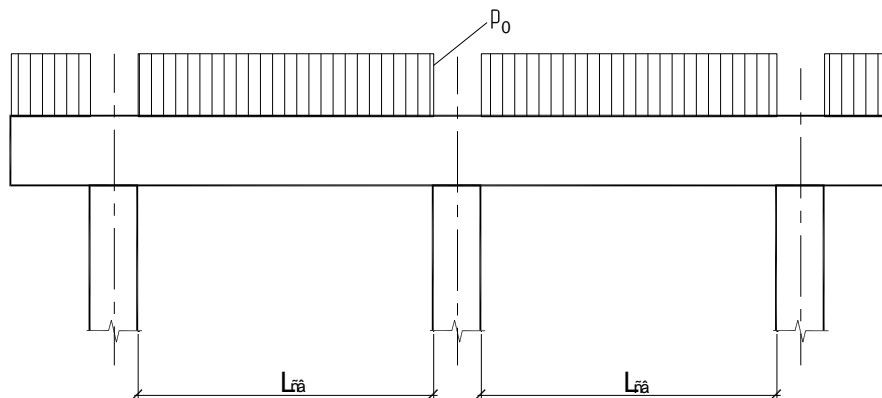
Схема к определению нагрузки на ростверк
